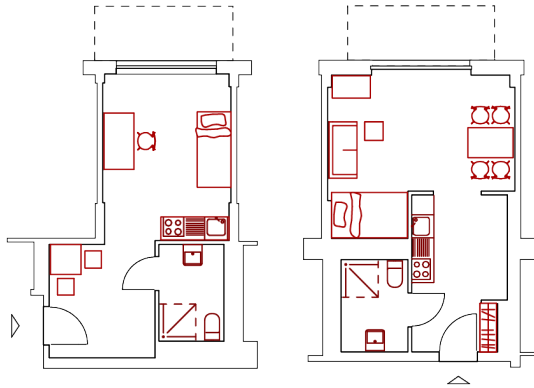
Grundriss Berlin-Marzahn,
